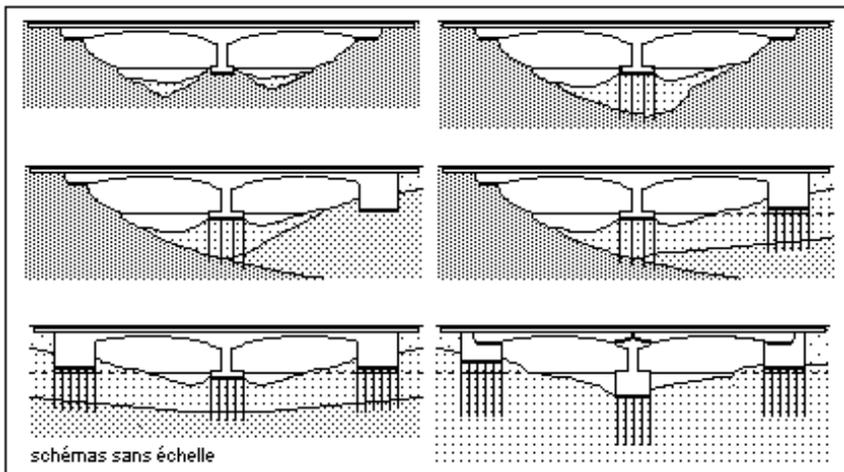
Fondations d'un pont selon la structure du site
